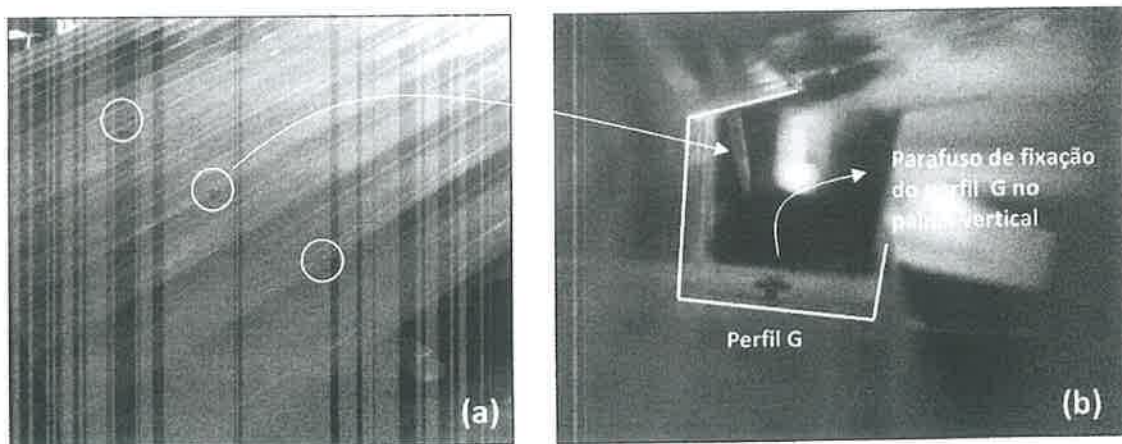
(a) Vista parcial da telha com os pontos de fixação na capa da telha trapezoidal; (b) Detalhe do parafuso de fixação da telha no perfil G e do parafuso que fixa o perfil G no painel vertical (parede).
